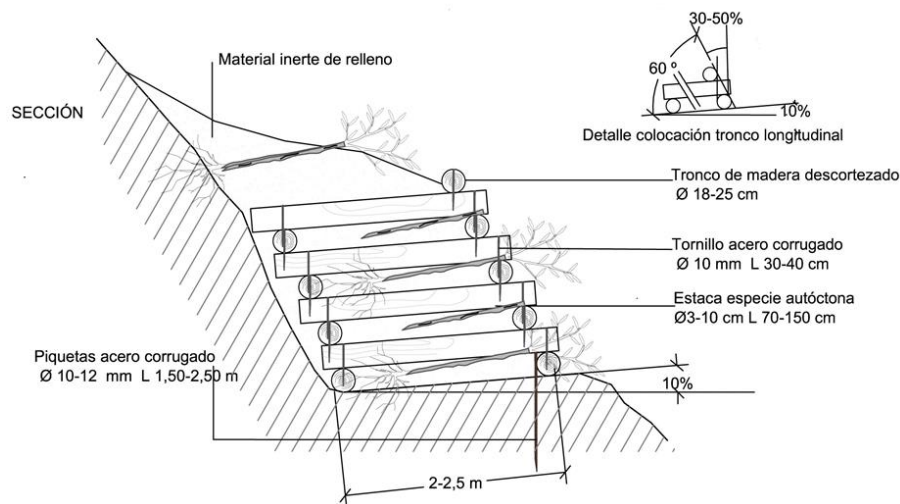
Esquema de la sección de un entramado doble vivo de madera y el detalle de colocación del tronco longitudinal. Fuente: (NTJ, 2017)
